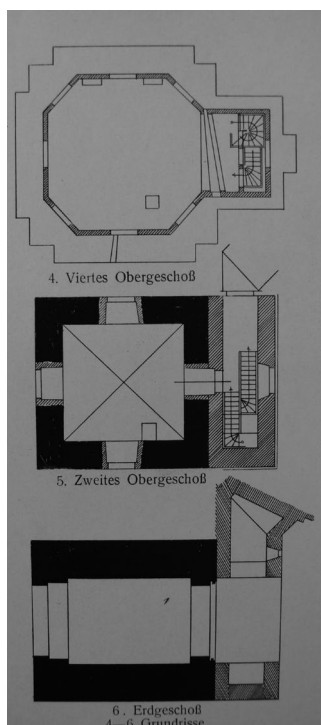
Grundrisse der Stockwerke nach Umbau des Zwehrenturmes von du Ry
